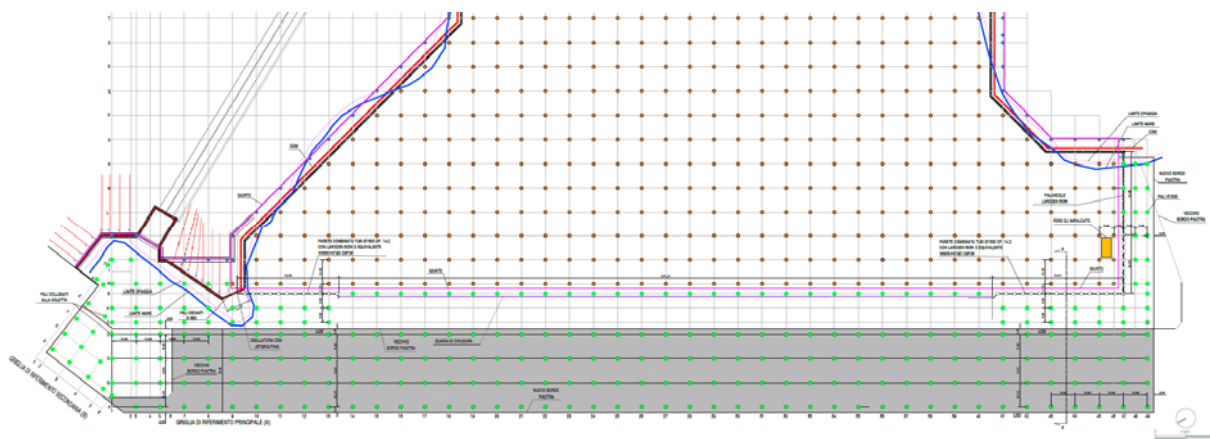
Stralcio delle planimetria di progetto (Cfr EG 05)
